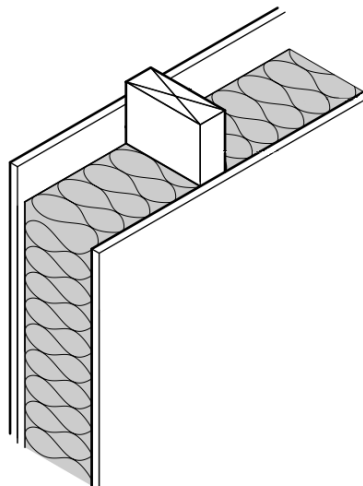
Camada de isolamento no interior do *timber-frame
